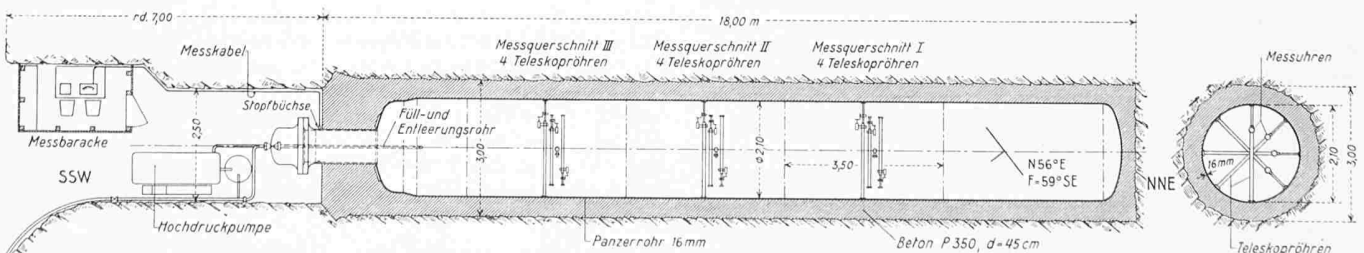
Installationsskizze des Panzerrohrversuchs Rothenbrunnen. Masstab 1:160
